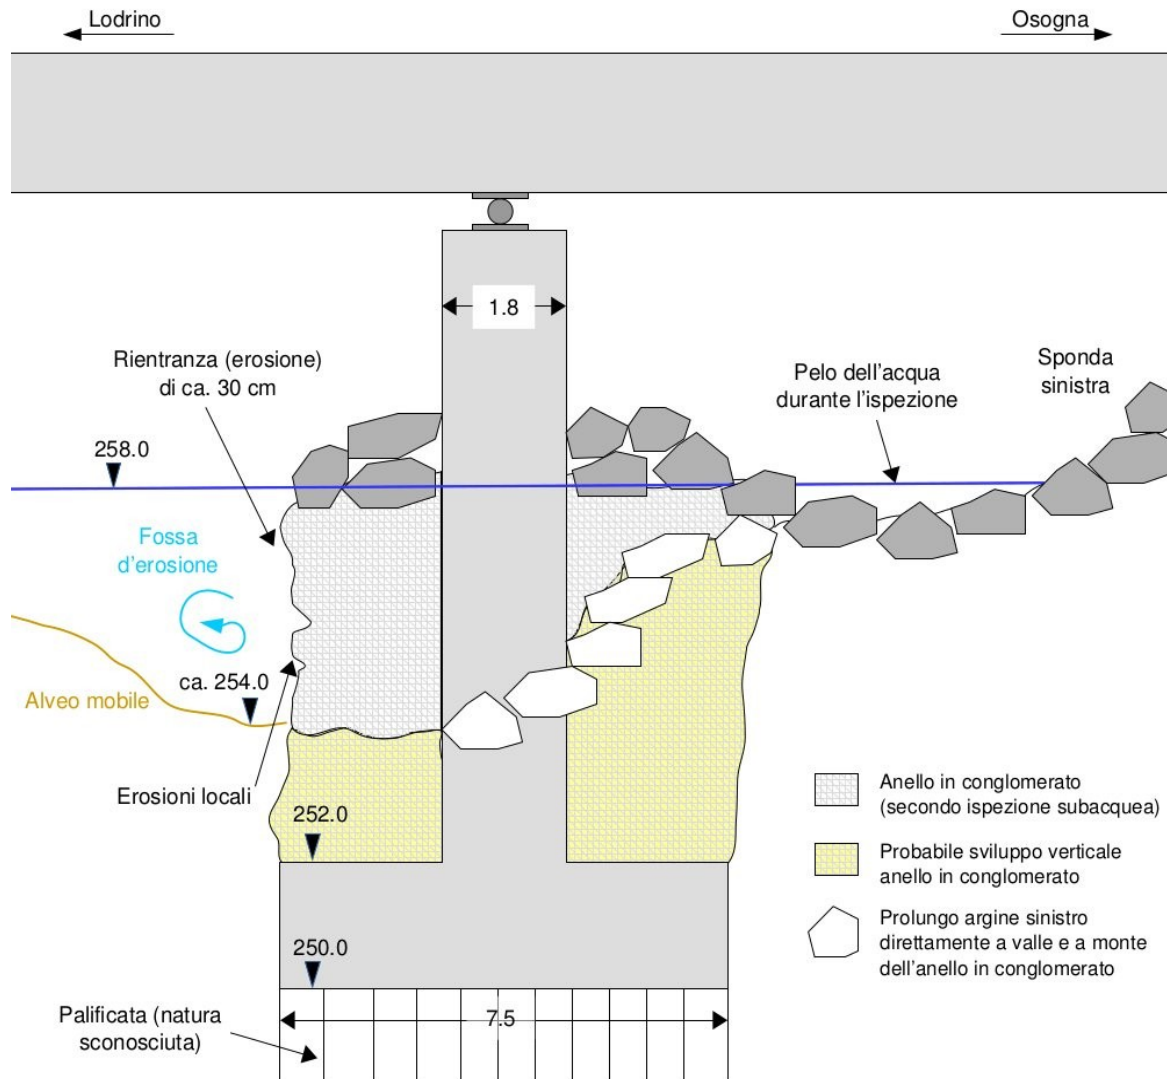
Rappresentazione schematica della possibile struttura dell'anello di conglomerato attorno alla pila est (sezione, vista verso monte). Fonte piani vedi /3/.
